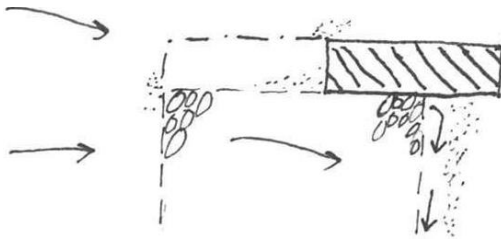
Bovenaanzicht met beginnende zijdelingse pipegroei aan de benedenstroomse zijde van de grofzandbarrière.
